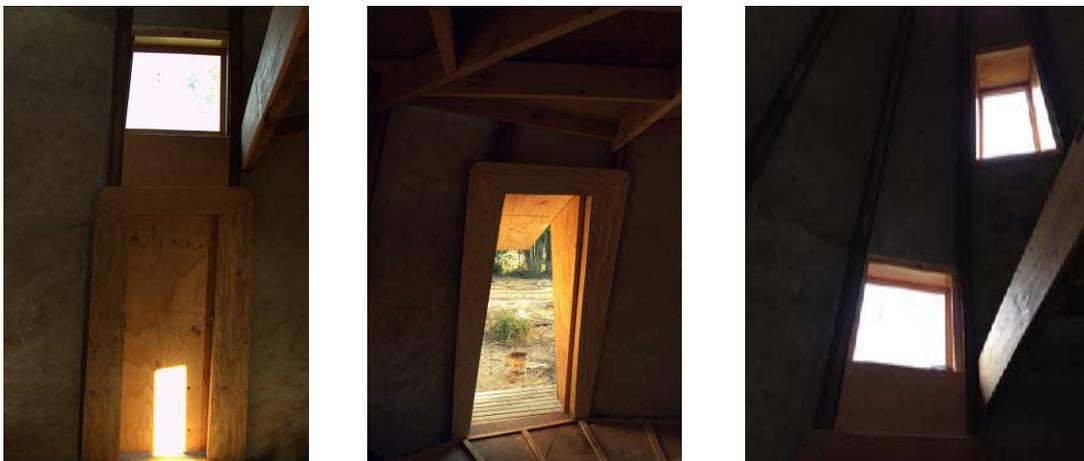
Detalles carpintería interior; accesos principales y vanos superiores este, sureste
